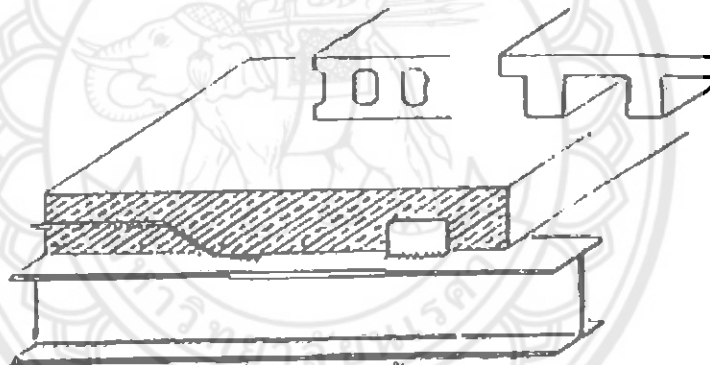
รายละเอียด Topping บน Steel Deck
